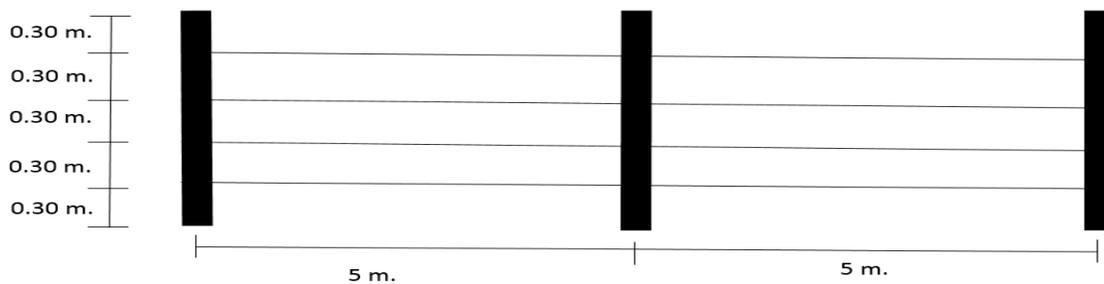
Características del cerco perimetral de la farmacia viviente.
